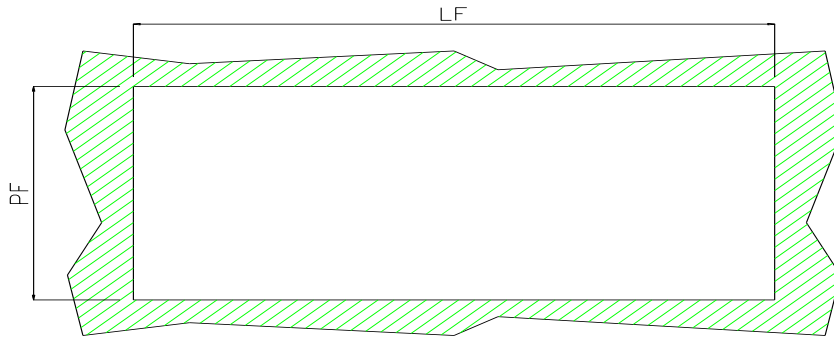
SCHEMA DI INSTALLAZIONE- INSTALLATION DIAGRAM - INSTALLATIONSSCHEMA - SCHEMA D'INSTALLATION
